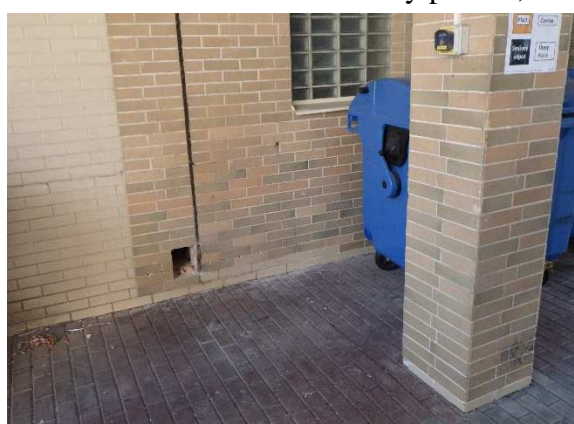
;70 –sonda NS-A2 – přiblížení, detail obnažené části;
